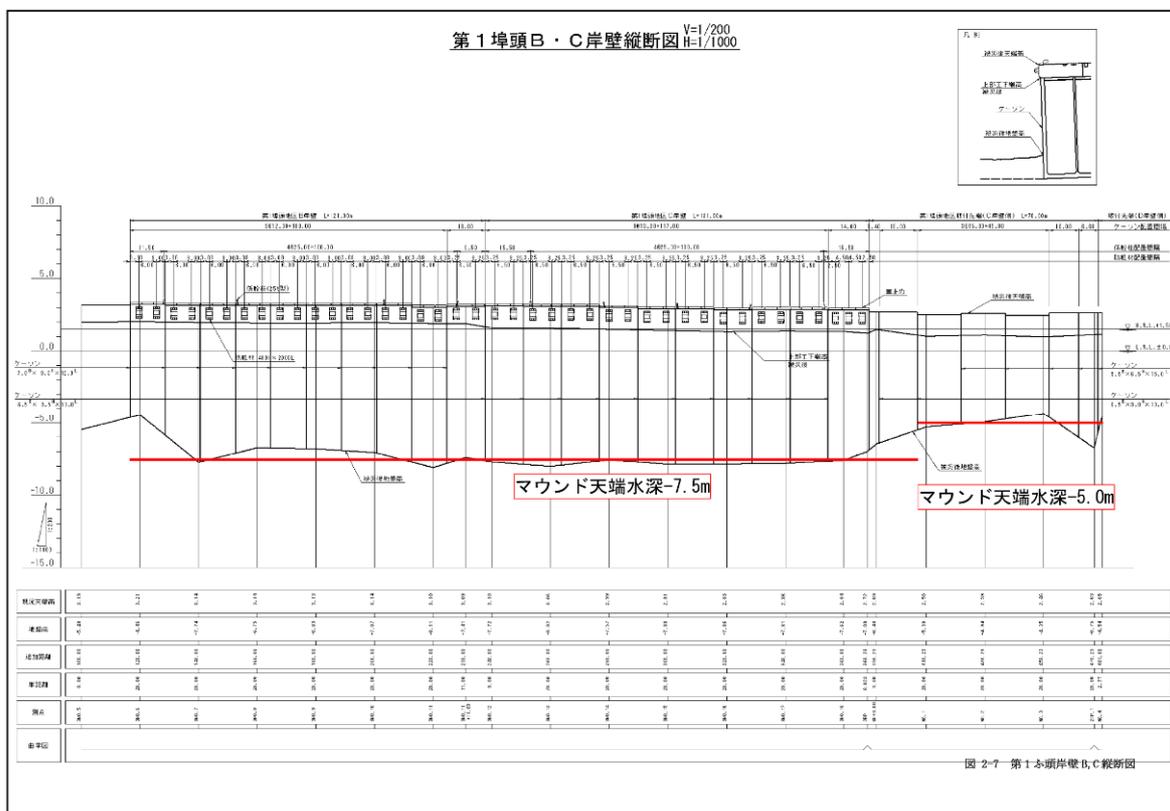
No.2 日立港区_第1ふ頭地区 1-B 岸壁 (-7.5m) の縦断面図 (被災後)
